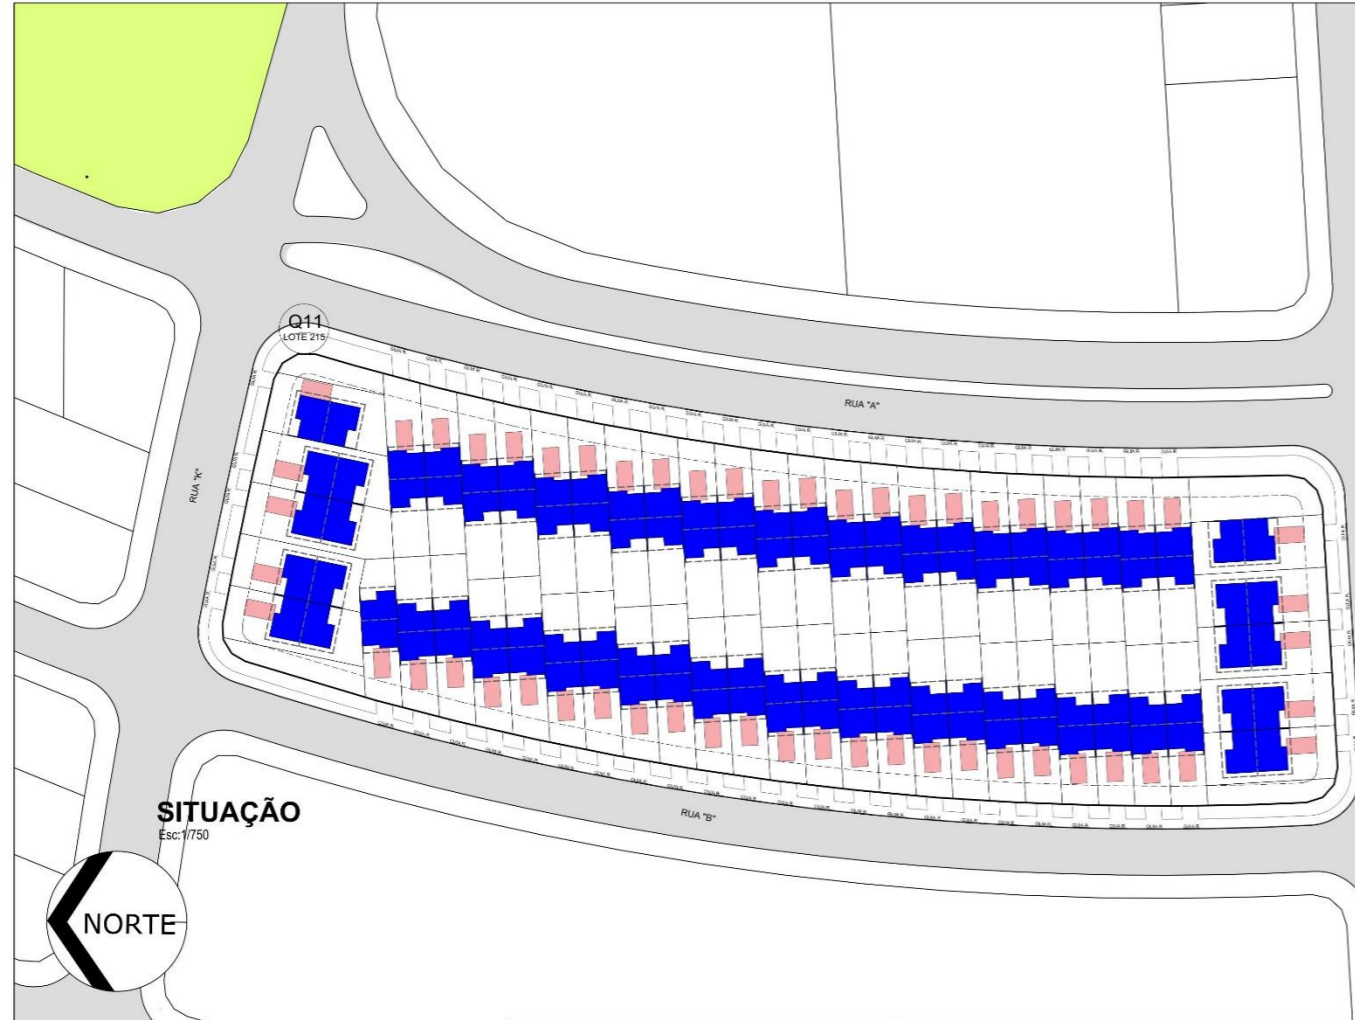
Projeto Urbanístico – Planta de Situação da Quadra 10 (Prancha 01)
